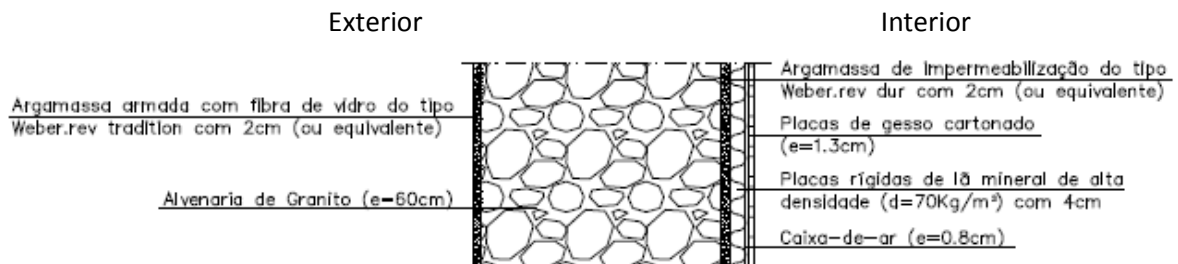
Pormenor construtivo da parede Pe1 [17]
